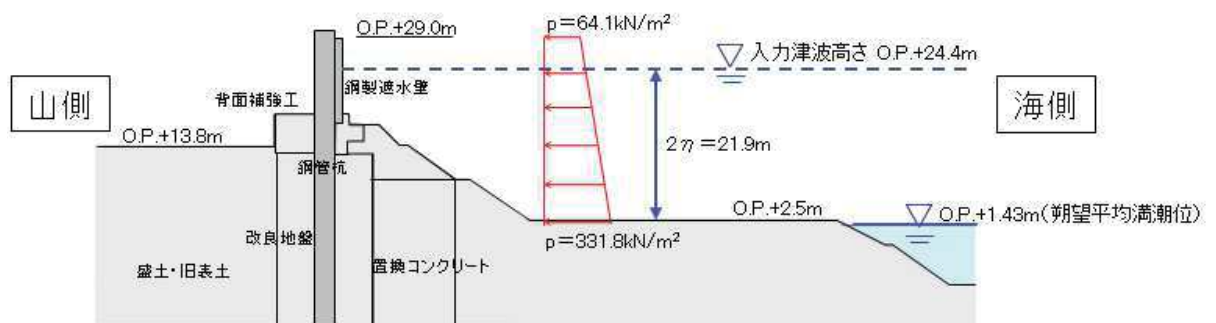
津波波圧設定の考え方（防潮堤（鋼管式鉛直式）の断面図）
